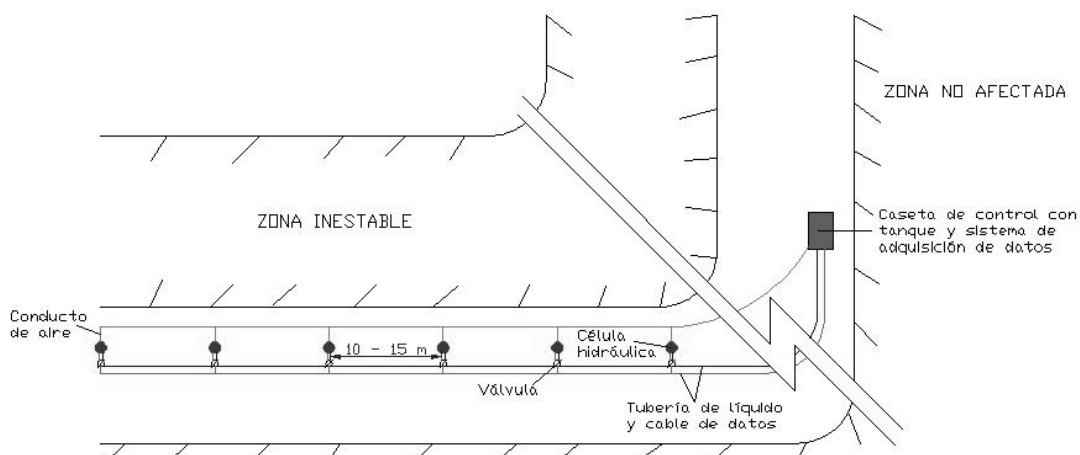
10. Vista en planta de colocación de células hidráulicas
